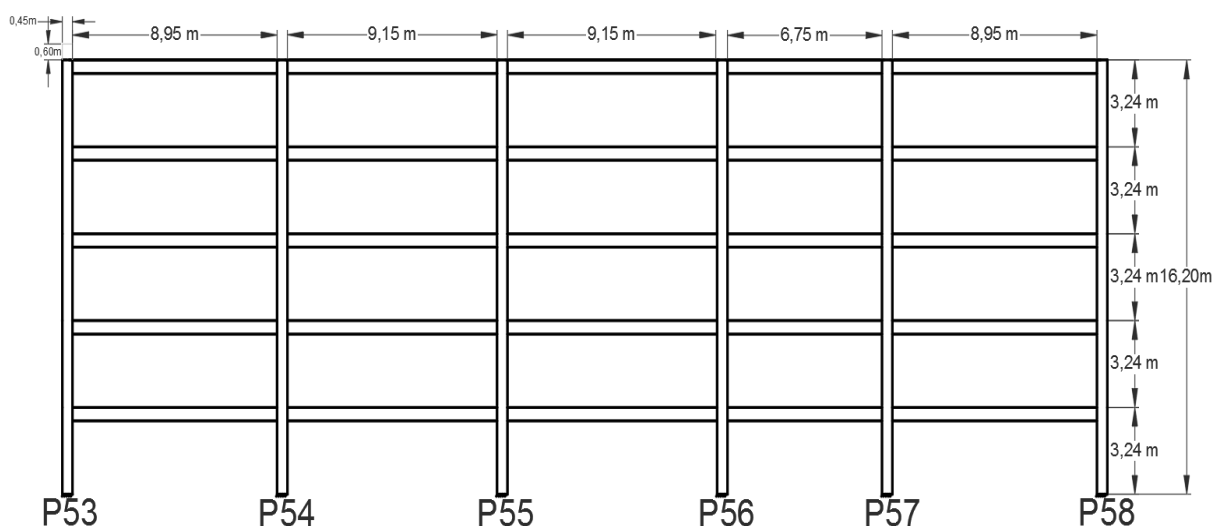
Vista en alzado del pórtico 7 de la estructura
